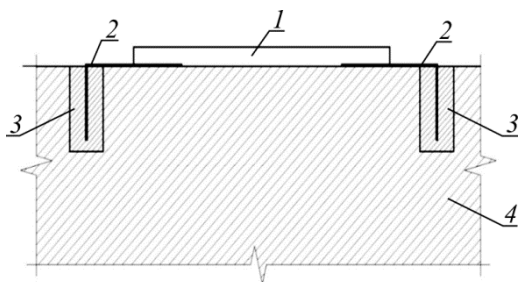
Подготовка, армирующая основание фундаментной плиты, с защемлением краев полотна геосинтетического материала перпендикулярно плоскости подошвы фундамента: 1 – фундаментная плита; 2 – армирующий геосинтетический материал; 3 – уплотненный грунт; 4 – грунт основания
